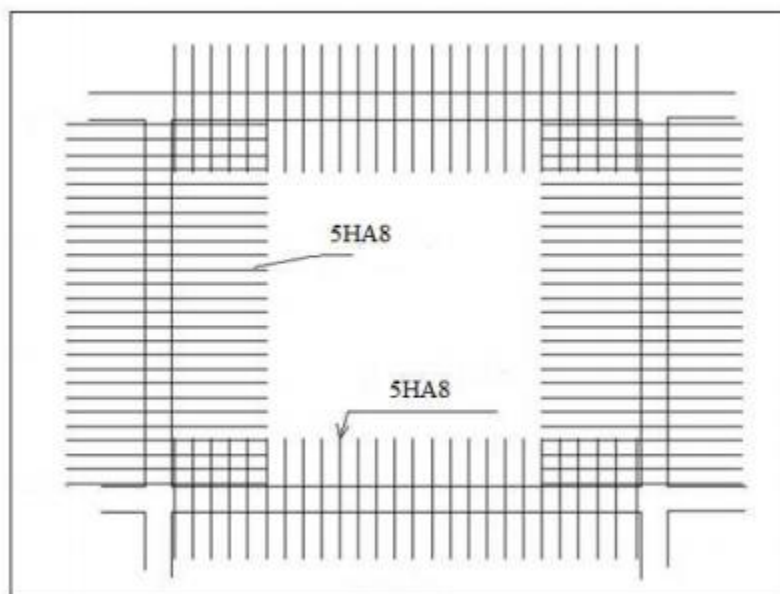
Ferrailage de dalle "cage d'escalier" en appui .
